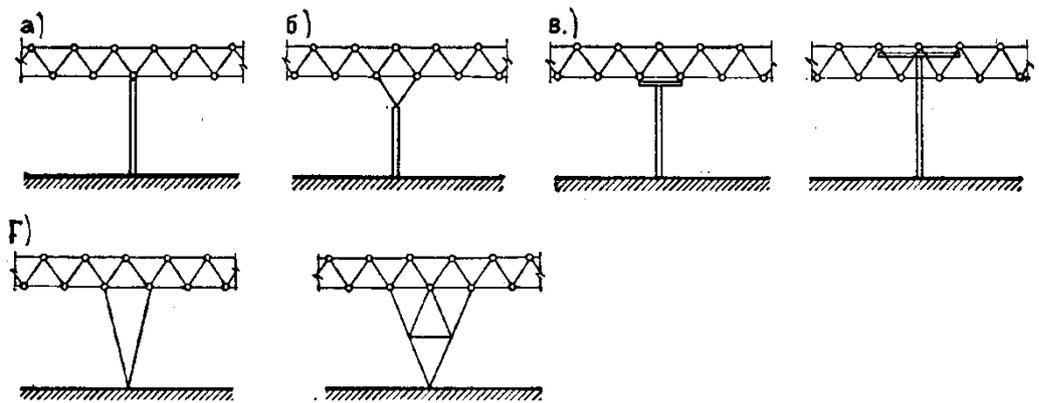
Варианты решения опор для перекрестно-стержневых плит:
